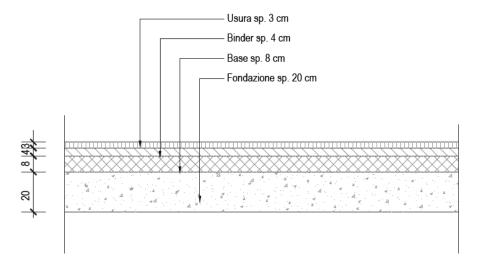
Pacchetto di pavimentazione NV04.1 e Viabilità parcheggio
